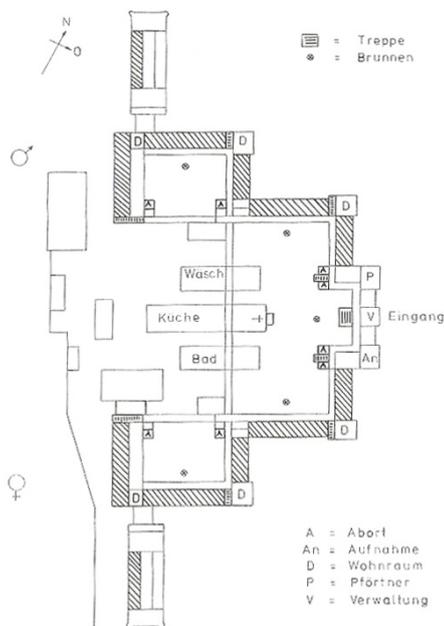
Grundriss Landesirren- Heil- und Pflegeanstalt Linz Niederhart
